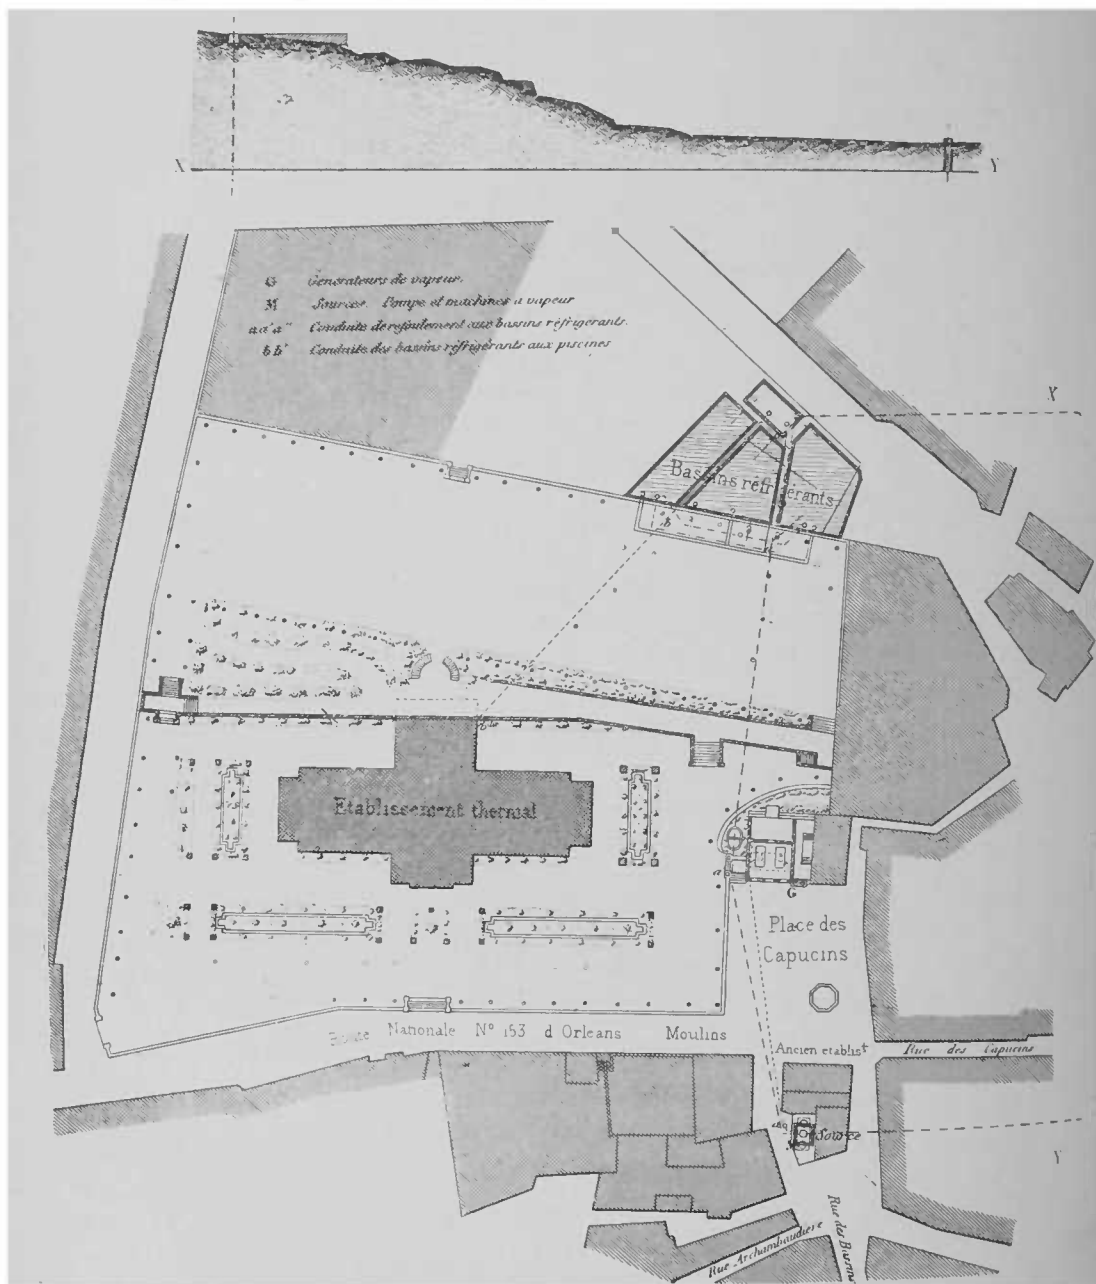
Plan général et profil en long des installations de captage et d'exhaussement à Bourbon-l'Archambault.
